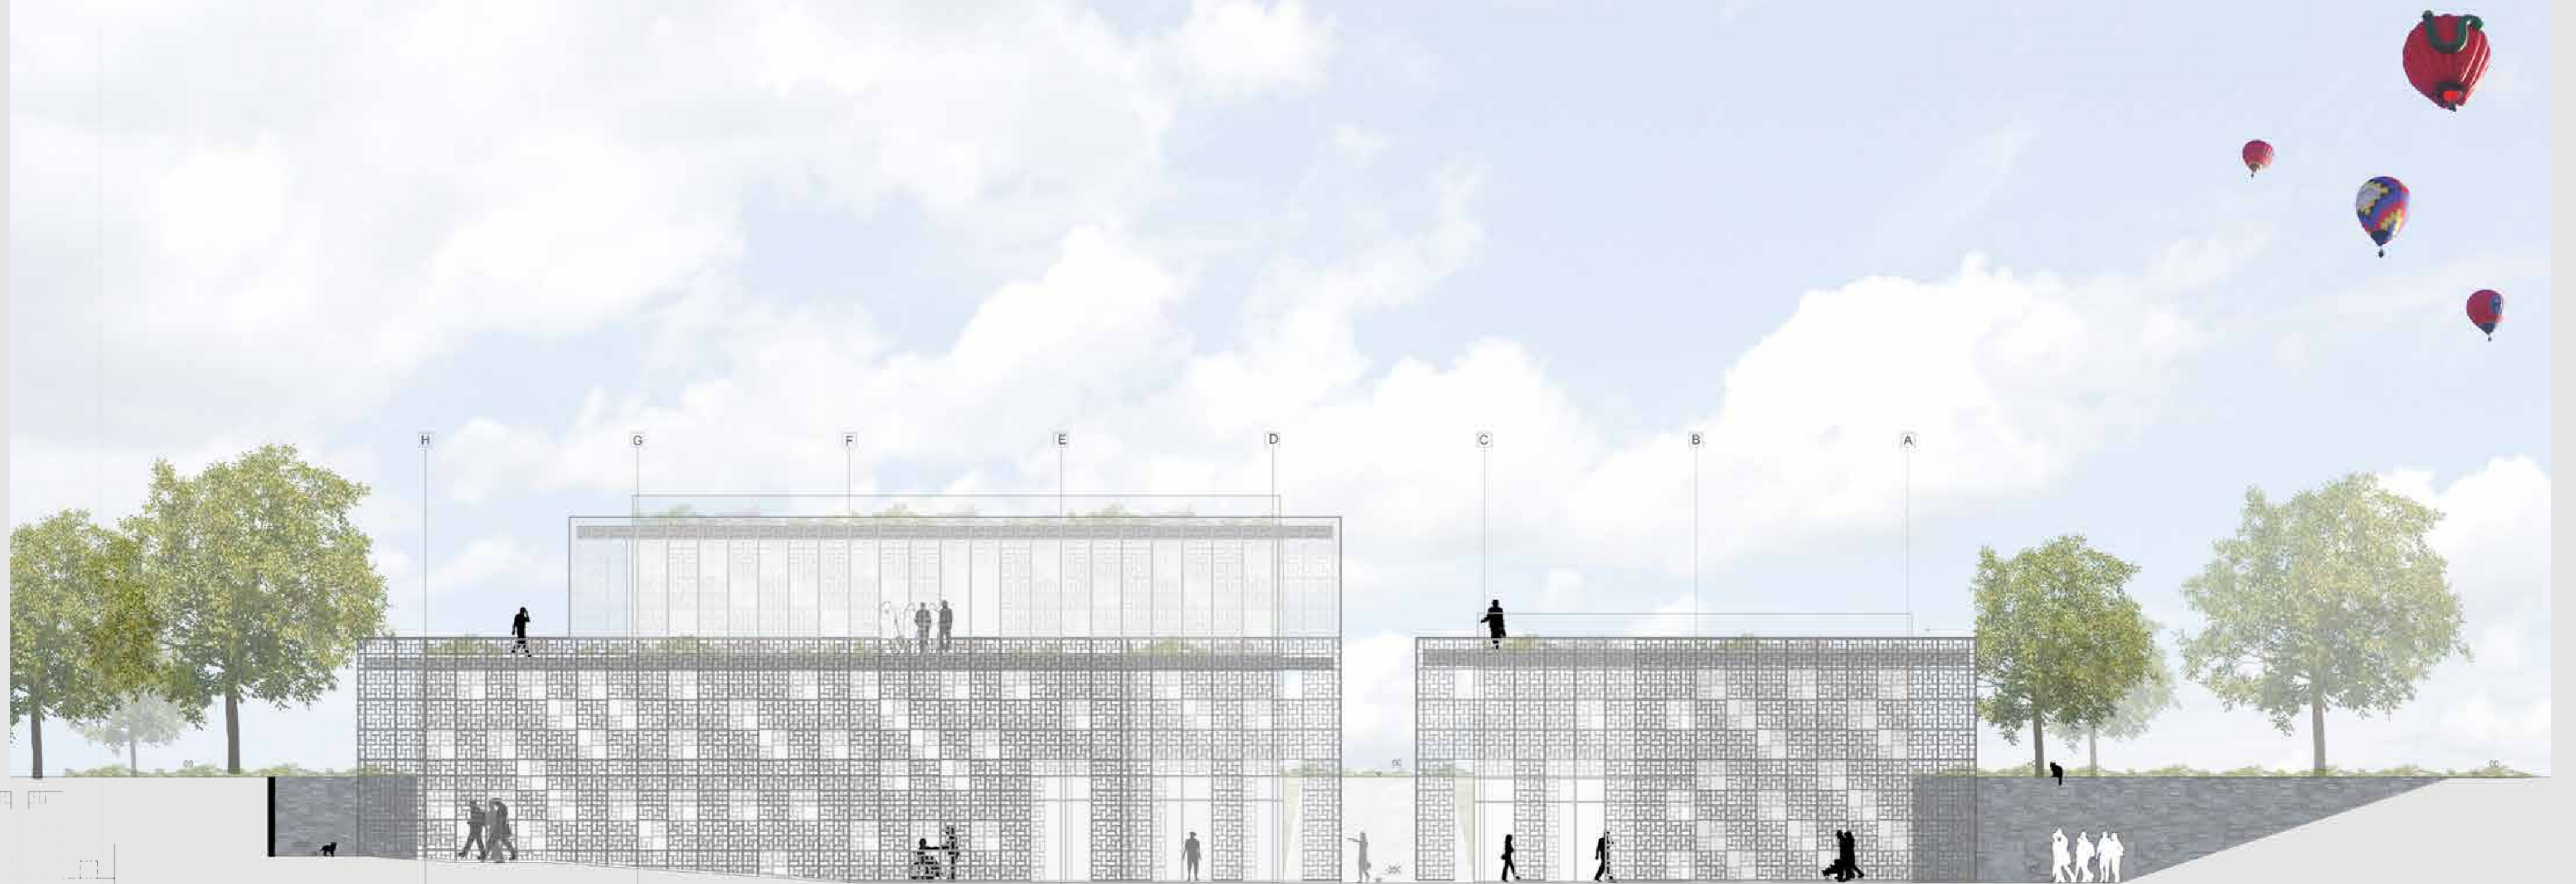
Prospetto Est interno alla corte - Scala: 1:200
